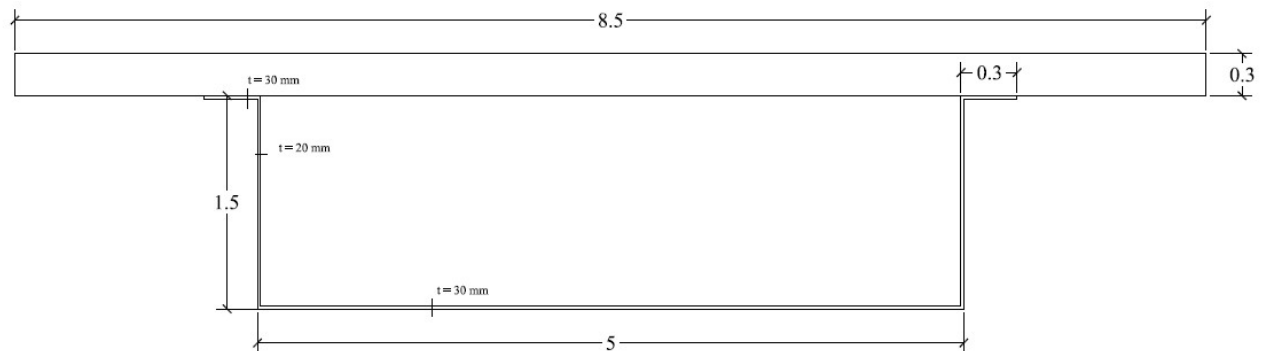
Sección del puente viga. Formada por la losa de hormigón y el perfil metálico.
